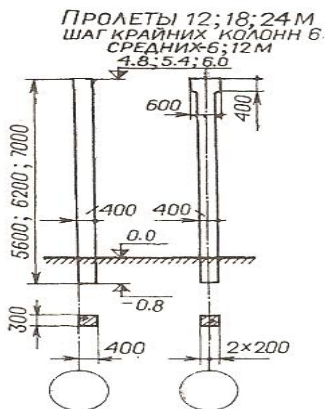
Типы железобетонных колонн для бескрановых зданий
